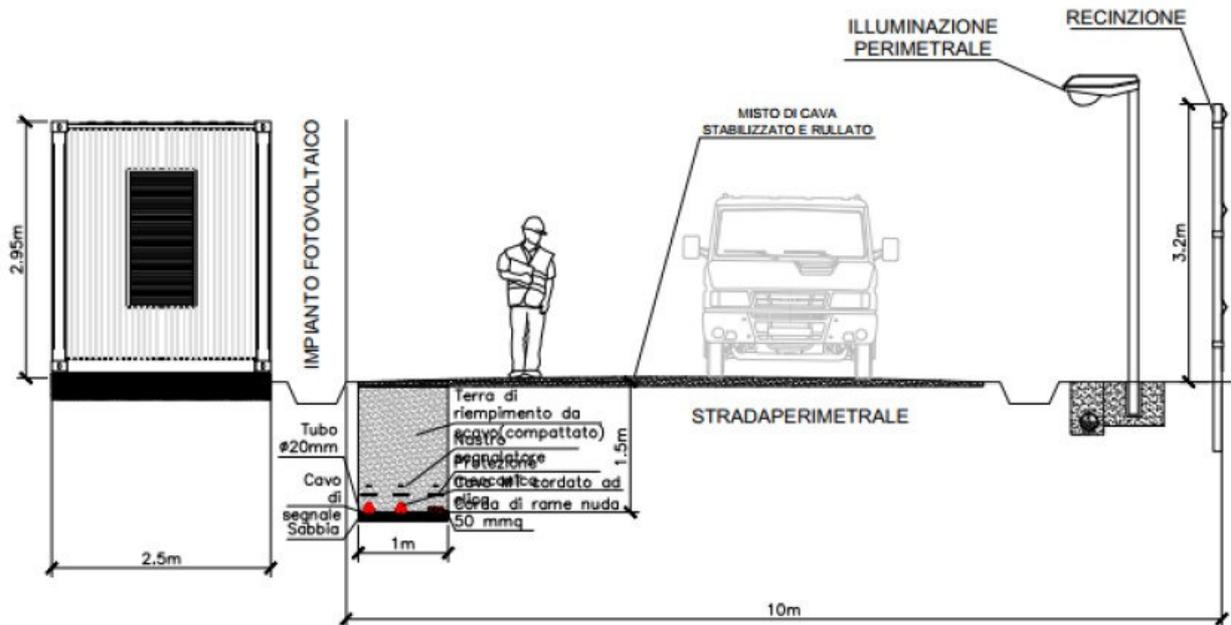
Canaletta in terra perimetrale all'area dell'impianto agrovoltaico
